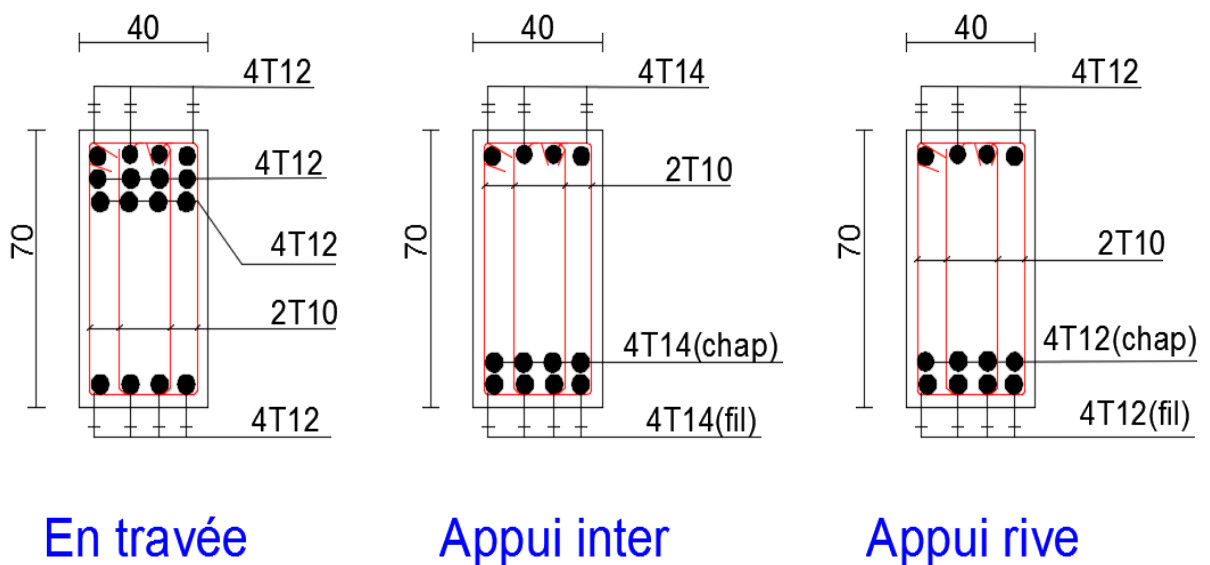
Ferrailage de la poutre de libage suivant le sens transversale.
